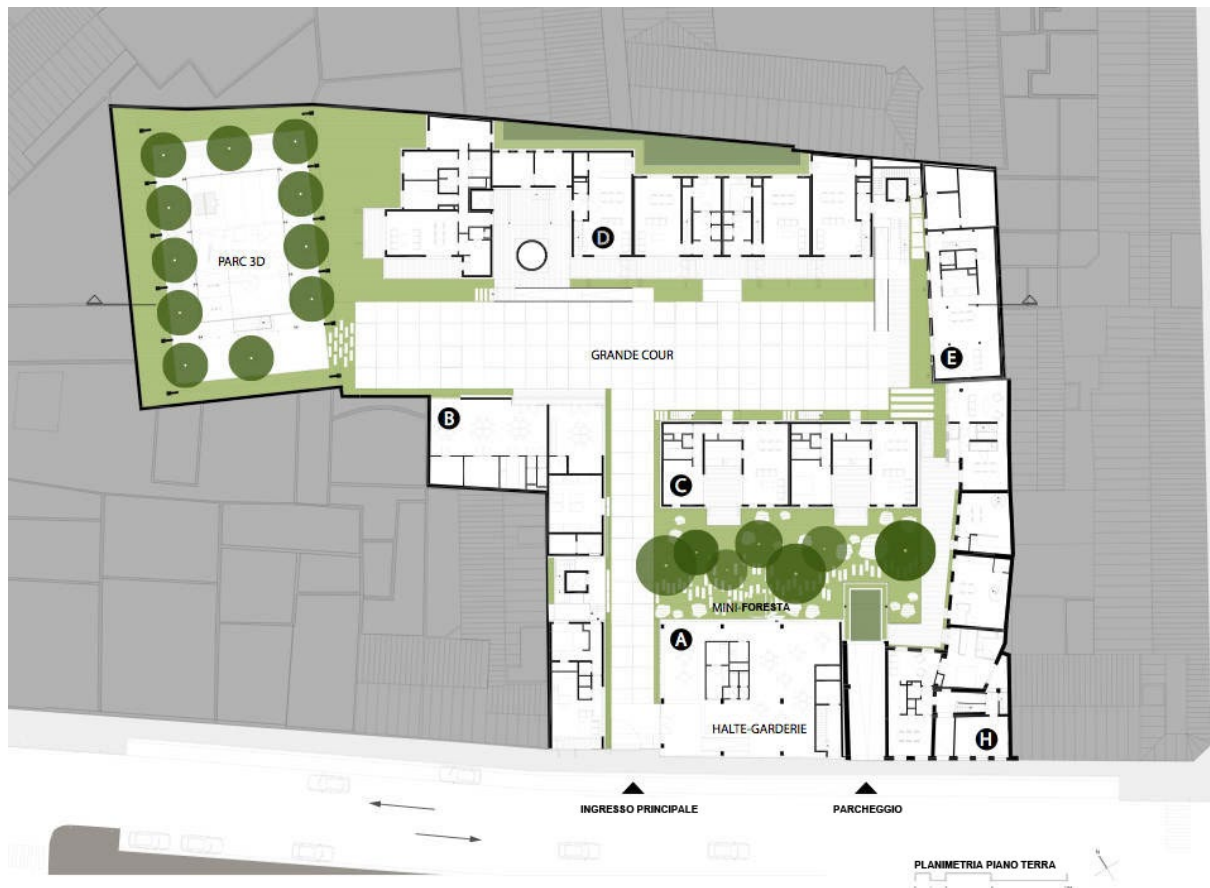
MDW Architecture, Savonneries Heymans, Bruxelles, 2011. Planimetria generale.
